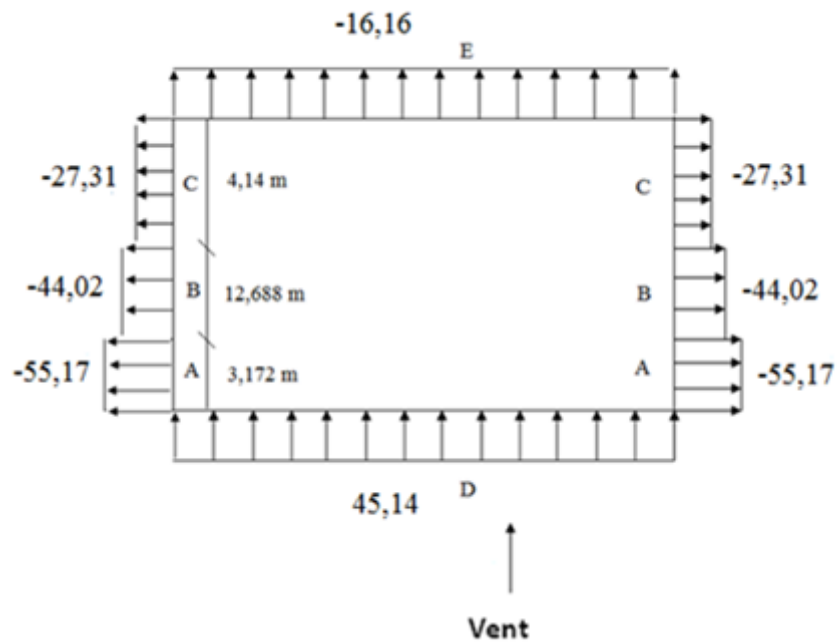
Pression statique du vent q_j sur les parois verticale (vent sur long pan1)
